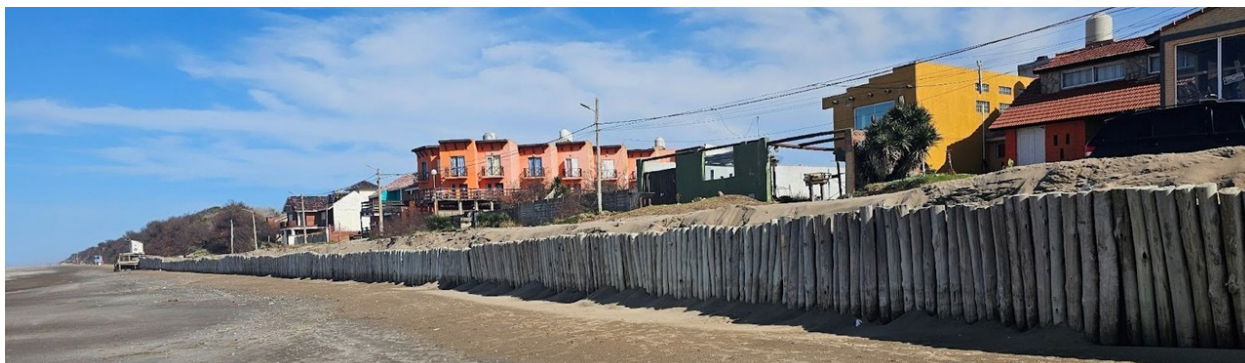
Muro de pilotes construido en El Silvio, Mar de Ajó (LC13).
